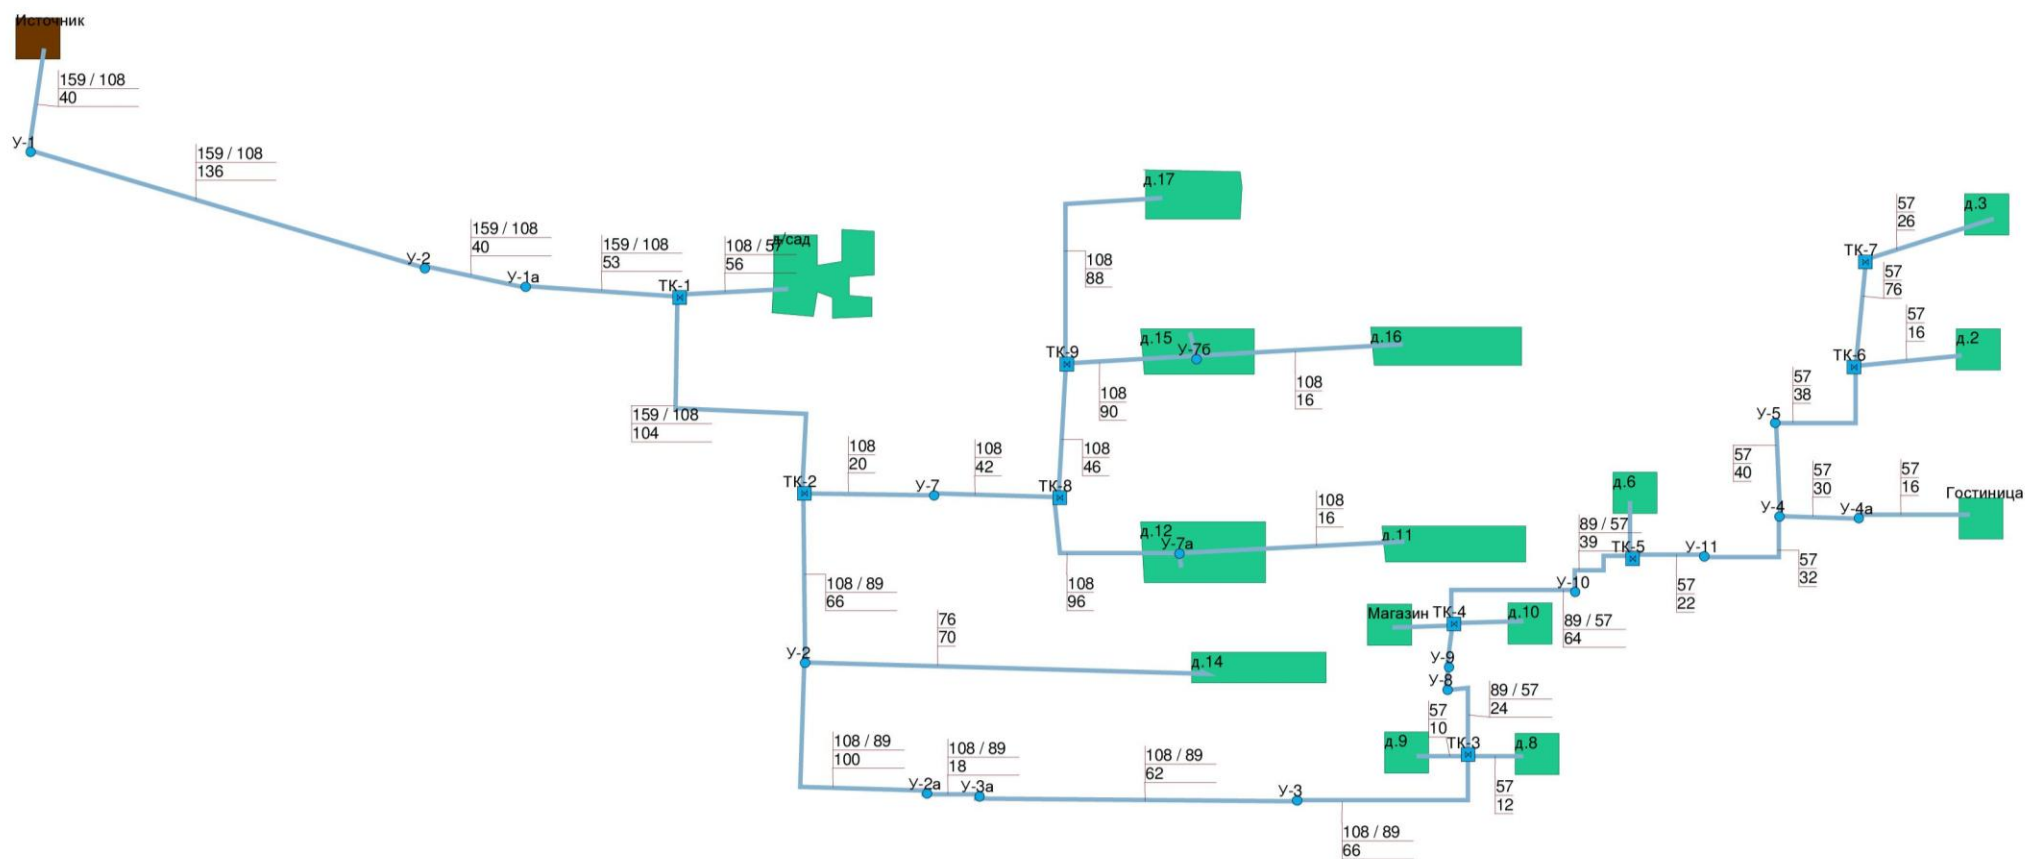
Схема тепловых сетей котельной п. Туношна военного городка № 26 (ГВС) в режиме наладки
